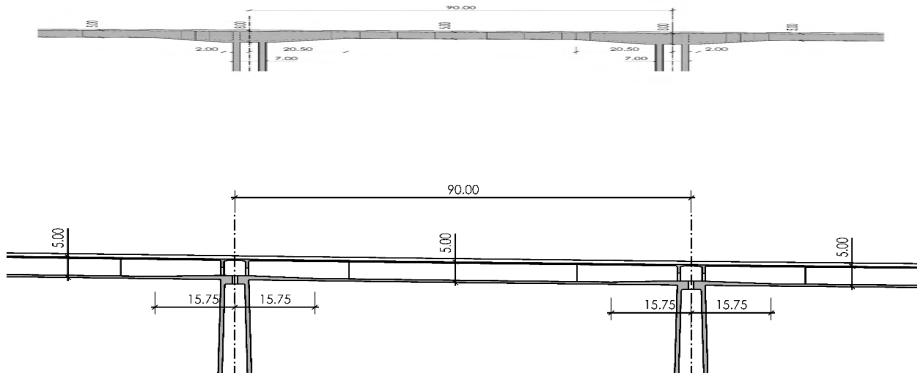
Alzado de un vano tipo de 90m – solución original de voladizos (en cima); alternativa vano a vano (abajo).
